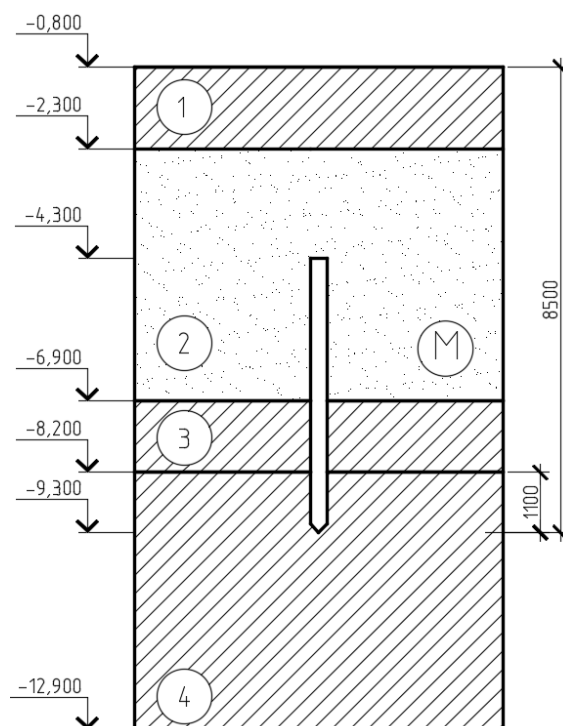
Схема расположения забивной сваи в грунте
